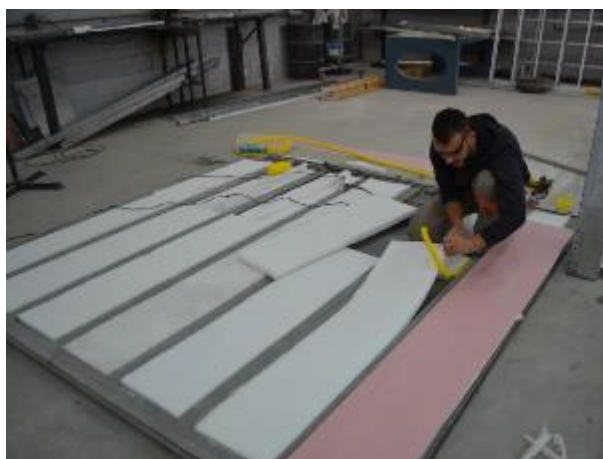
Montagem da instalação elétrica e colocação da lã de PET e chapa de *drywall*.
